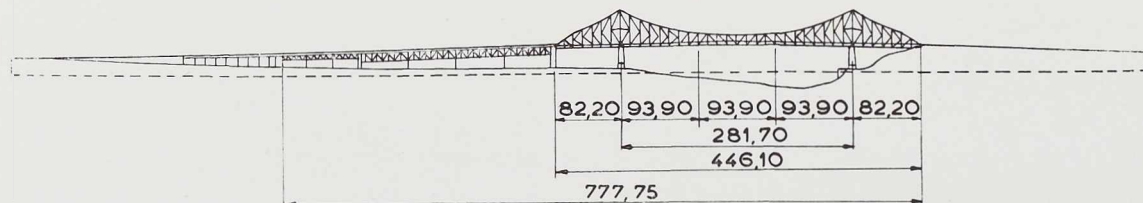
Elévation du pont Story à Brisbane (Australie).
